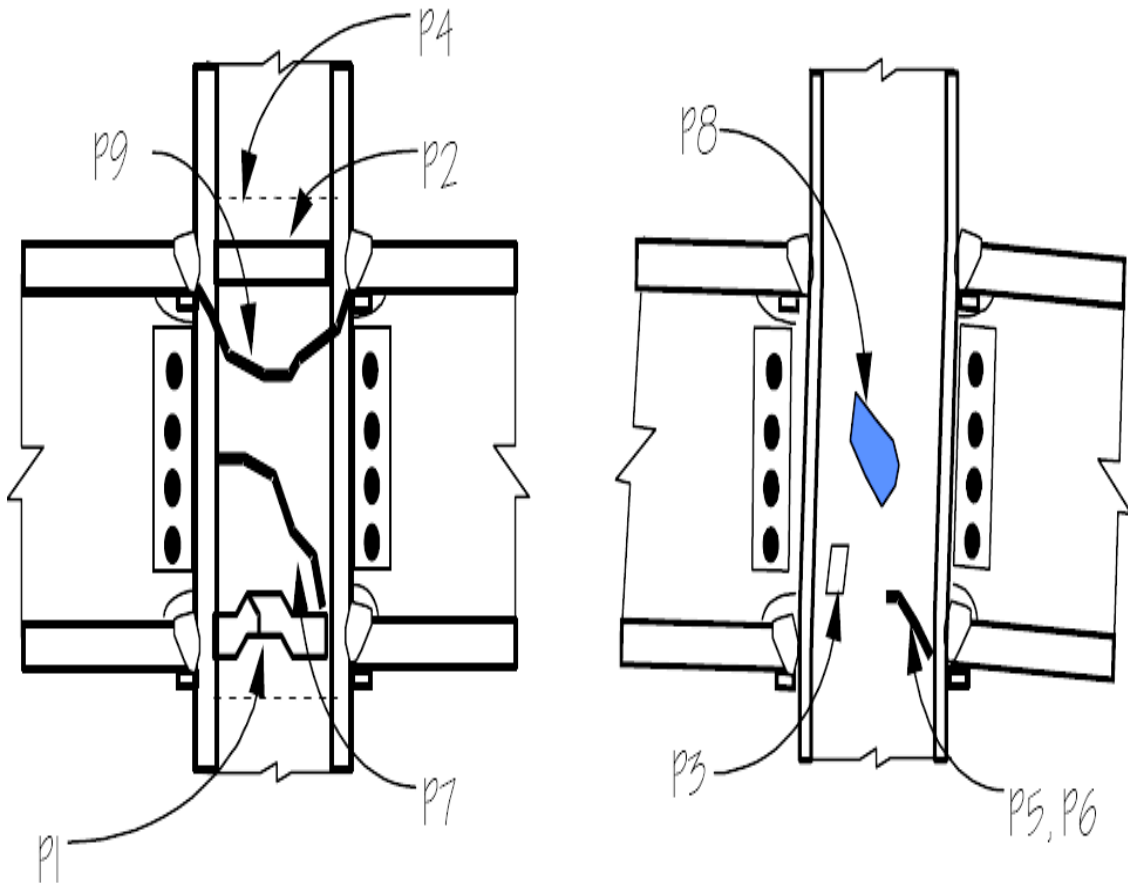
21 Fallas típicas en la zona del panel de unión (SAC Joint Venture, 2000).
